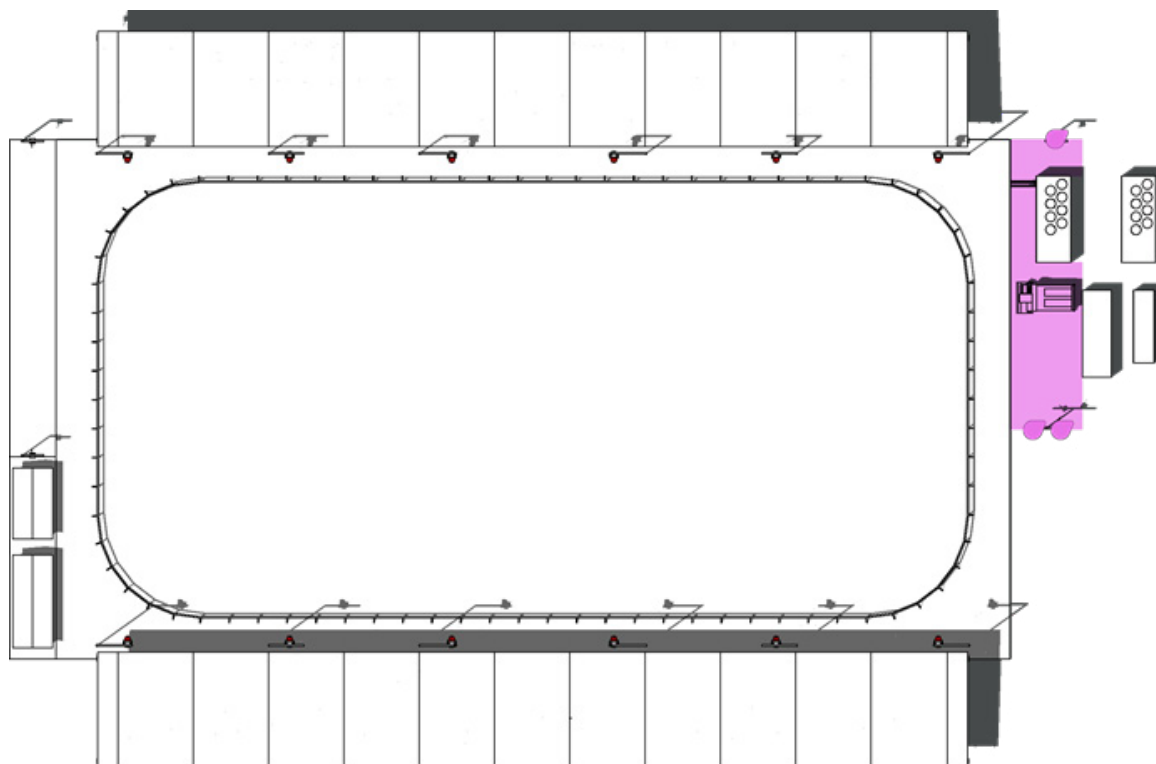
disposizione degli apparecchi per l'illuminazione dell'area impianti
